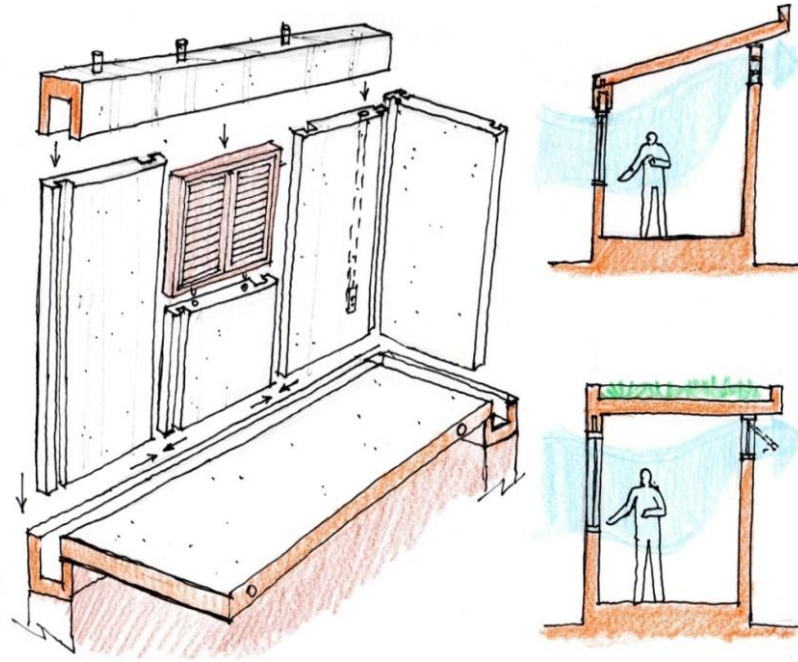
Proposta do sistema pré-fabricado em compósito cimentício e sistemas de ventilação naturais.
